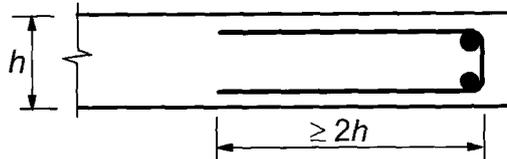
Randbewehrung an freien Rändern von Platten
